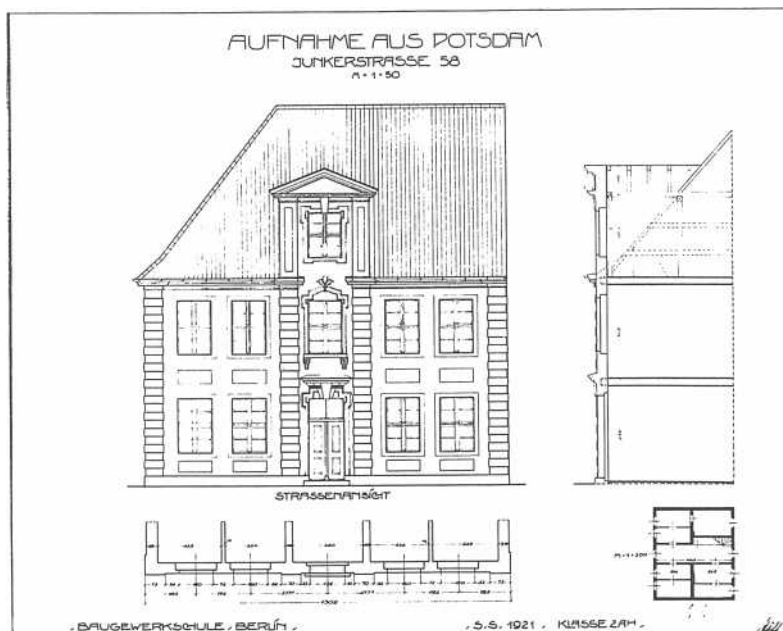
„Aufnahme aus Potsdam, Junkerstraße 58“ (heute Gutenbergstraße 93). Straßenansicht mit Vertikal- und Horizontalschnitt, Grundriss gezeichnet von Höftiges. Jockel Regbmstr. 1921 (Sommersemester), M (Ansicht, Schnitt) 1 : 50, M (Grundriss) 1 : 200, 61,8 x 50,2 cm, (Blattgröße), Federzeichnung auf Karton; Baugewerkschule Berlin, Inv.Nr. 190.
